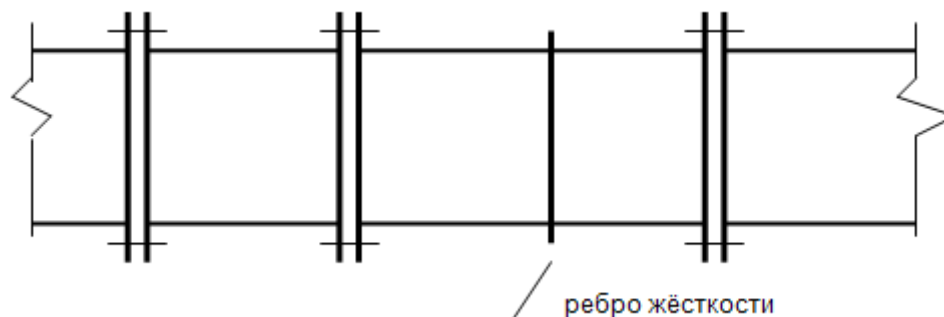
Принципиальная схема конструкции воздуховода из оцинкованной стали на фланцевых соединениях.
